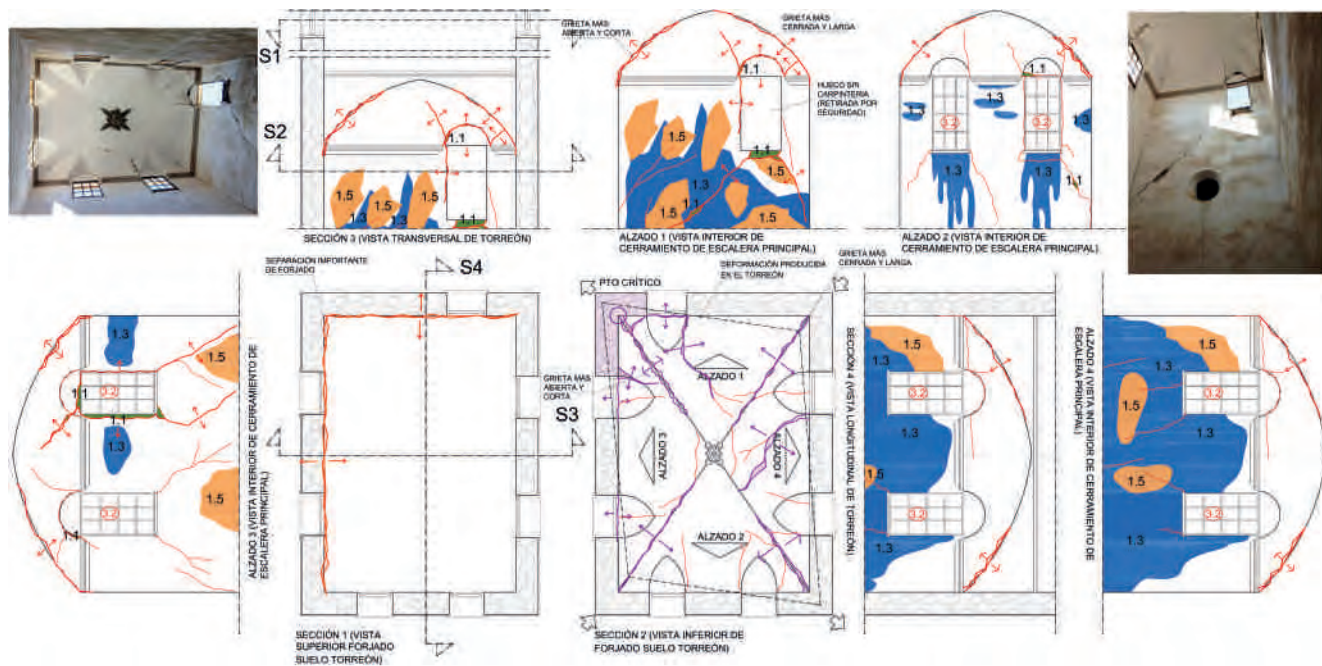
Plantas, alzados y secciones de la cara inferior del forjado del suelo del torreón, con indicación de los daños existentes.
